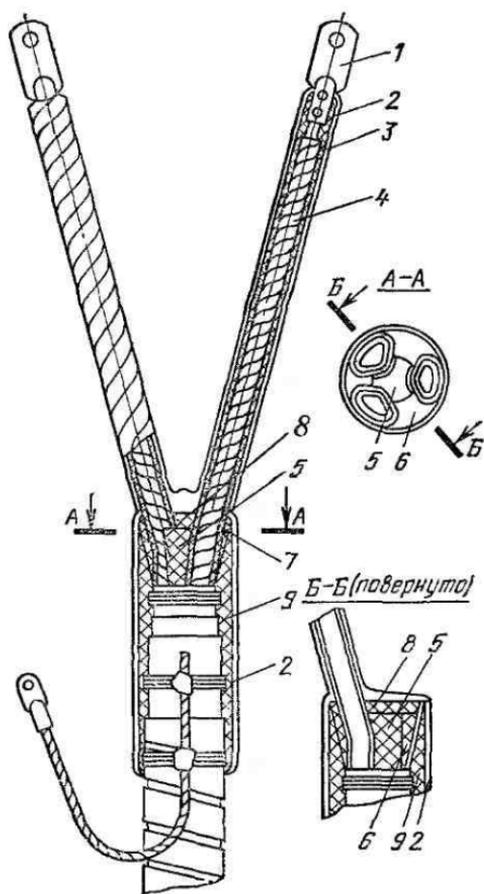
Общий вид концевой заделки КВсл: 1 — наконечник; 2 — подмотка из поливинилхлоридных лент; 3 — подмотка из лент ЛЭТСАР или ЛЭТСАР и ЛЭТСАР ЛПТ; 4 — бумажная изоляция жилы; 5 — центральный уплотнительный конусный вкладыш; 6 — боковой уплотнительный конусный вкладыш; 7 — бандаж из ленты ЛЭТСАР; 8 — крестовидная уплотнительная подмотка; 9 — герметизирующая подмотка из лент ЛЭТСАР или ЛЭТСАР и ЛЭТСАР ЛПТ
